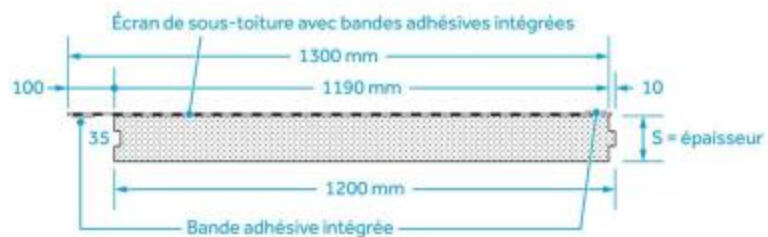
Panneaux Clima First Sarking coupe B-B'
